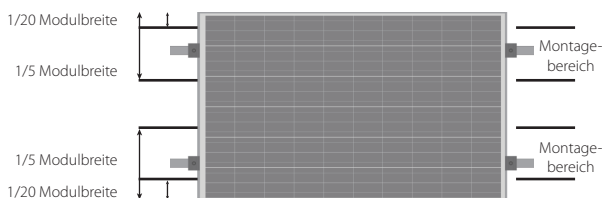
Mechanische Dimensionen, wenn die Module horizontal ausgerichtet mit der Klemmbefestigungsmethode installiert werden
